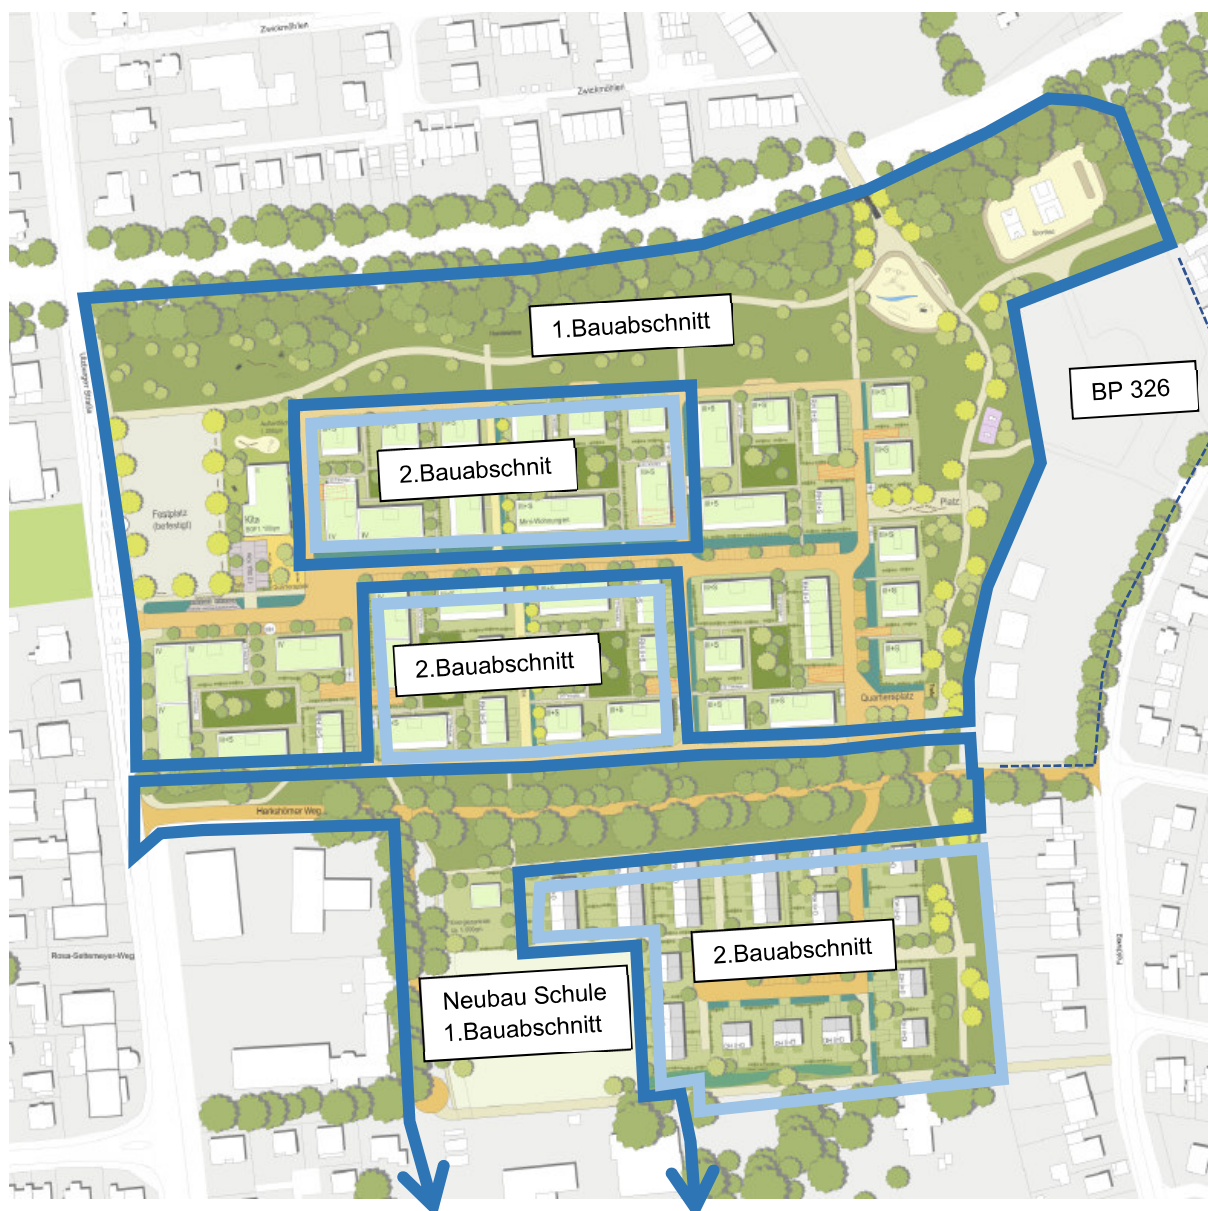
Rahmenplan „Harkshörner Weg“ mit Bauabschnitten (Grafik: WRS)
